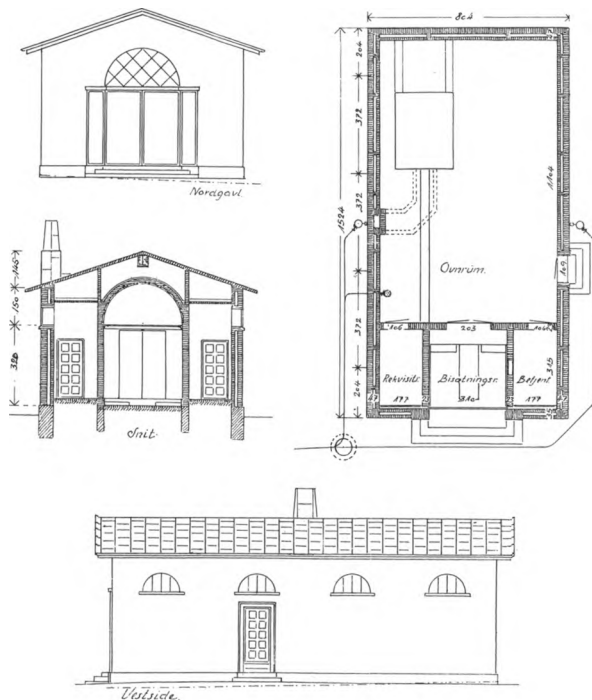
Krematorium på Østre kirkegård. Plan, tvær-snit samt nord- og vestfacade. 1:300. Tegnet af Marius Pedersen 1932. NM3. - *Crematorium in the cemetery, Østre kirkegård. Plan, cross-section, north and west elevation.
